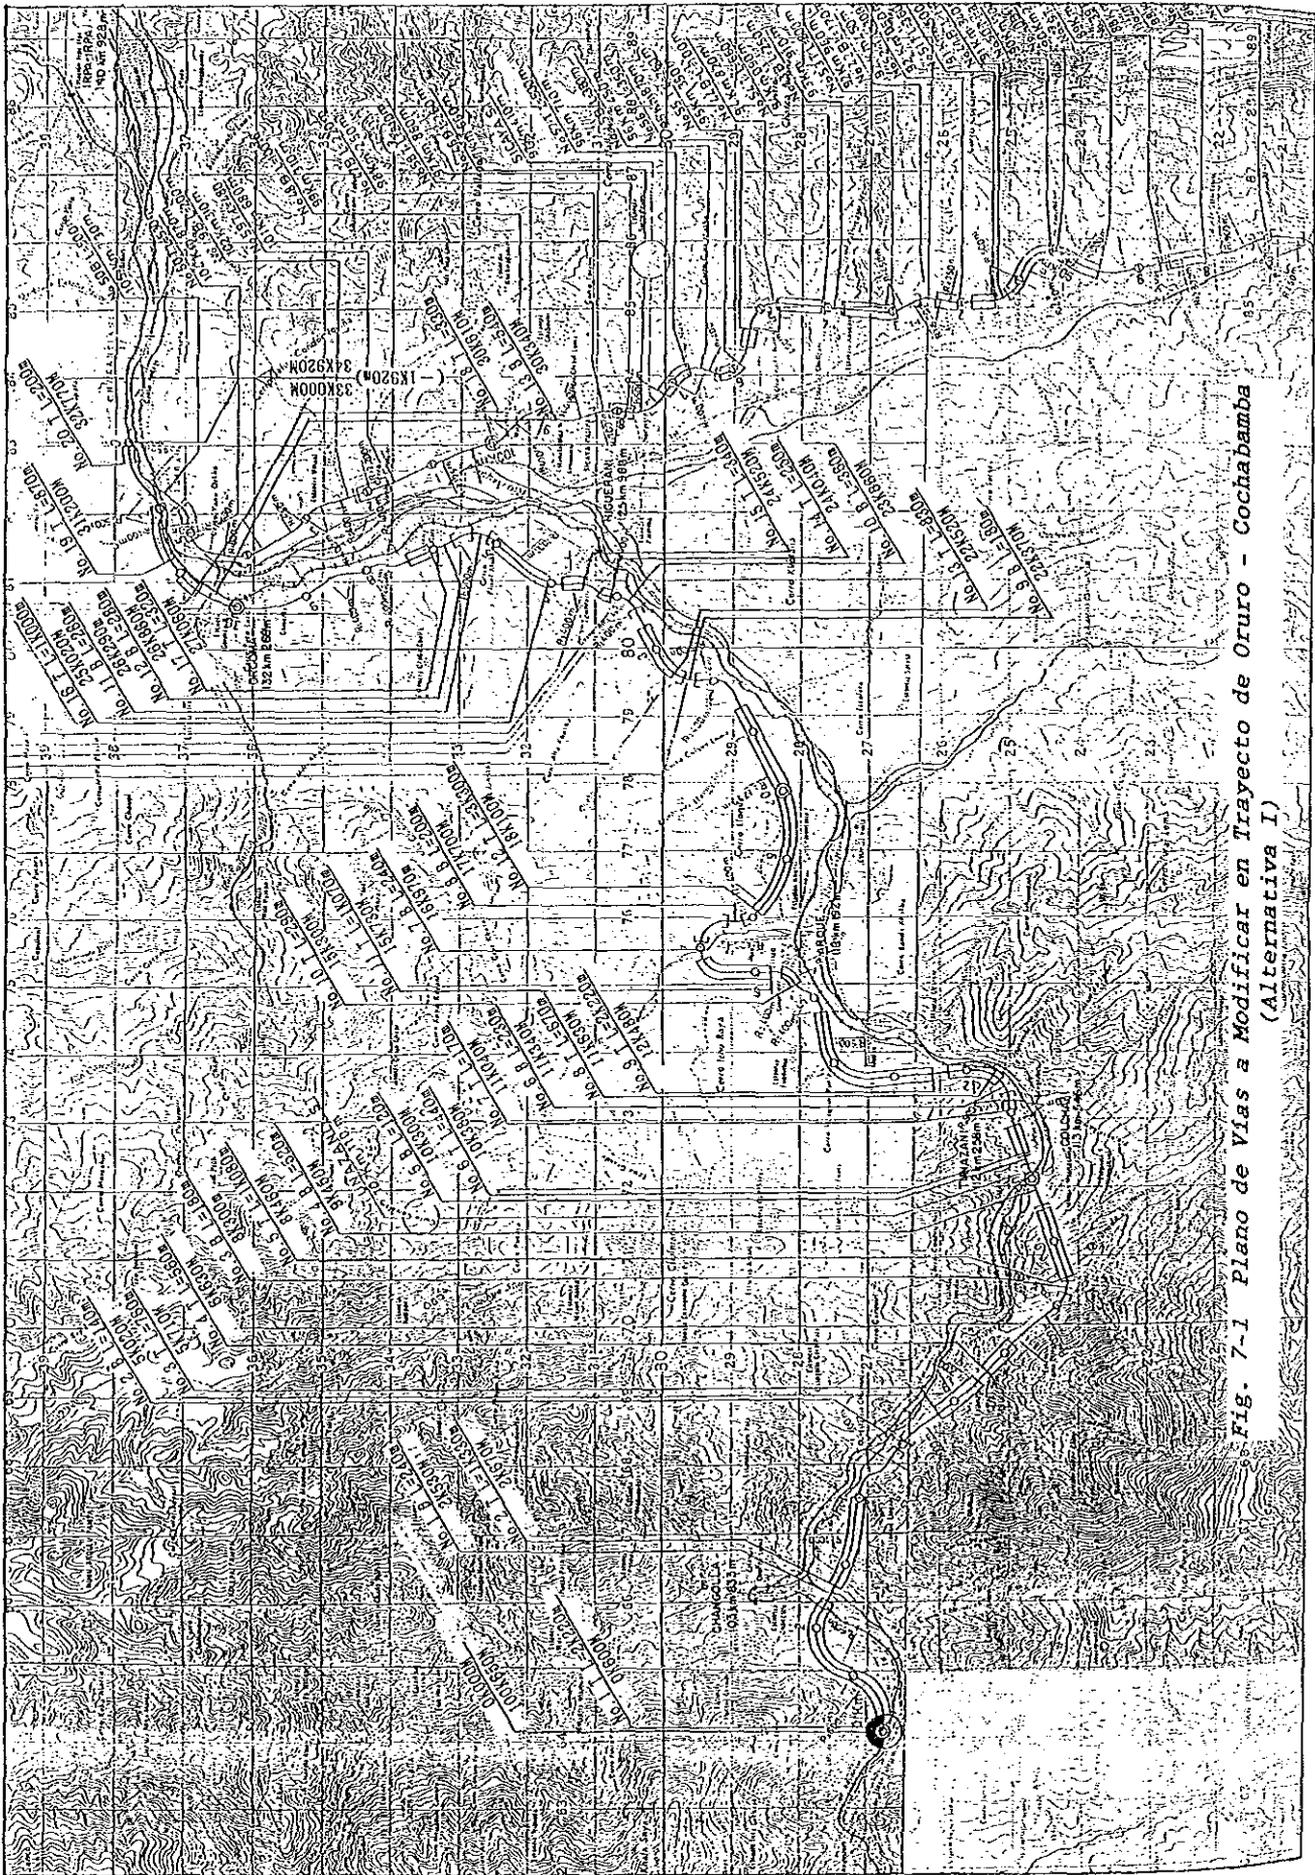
Plano de Vias a Modificar en Trayecto de Oruro - Cochabamba (Alternativa I)
